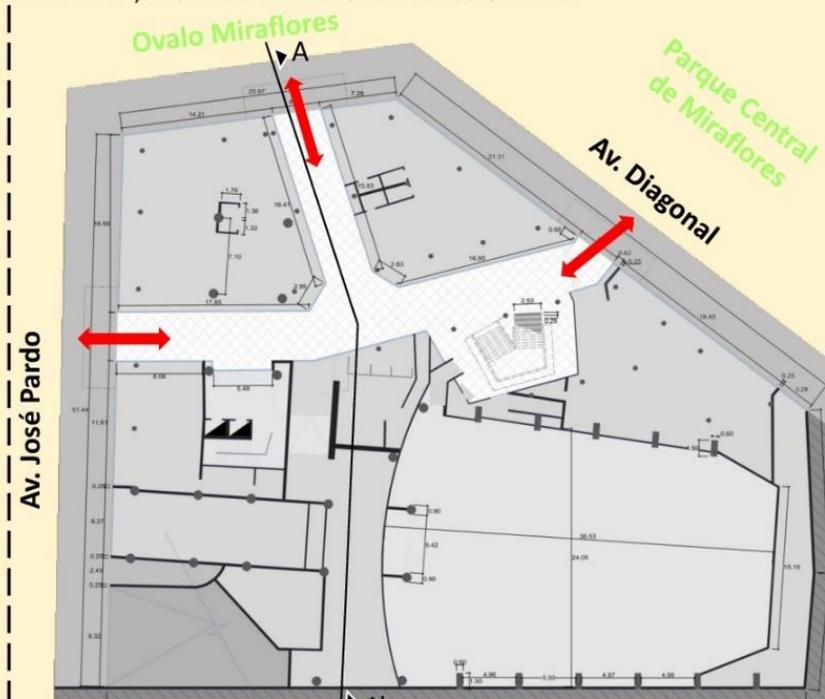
Plano de la primera planta escala: 1/500 Fuente: propia
